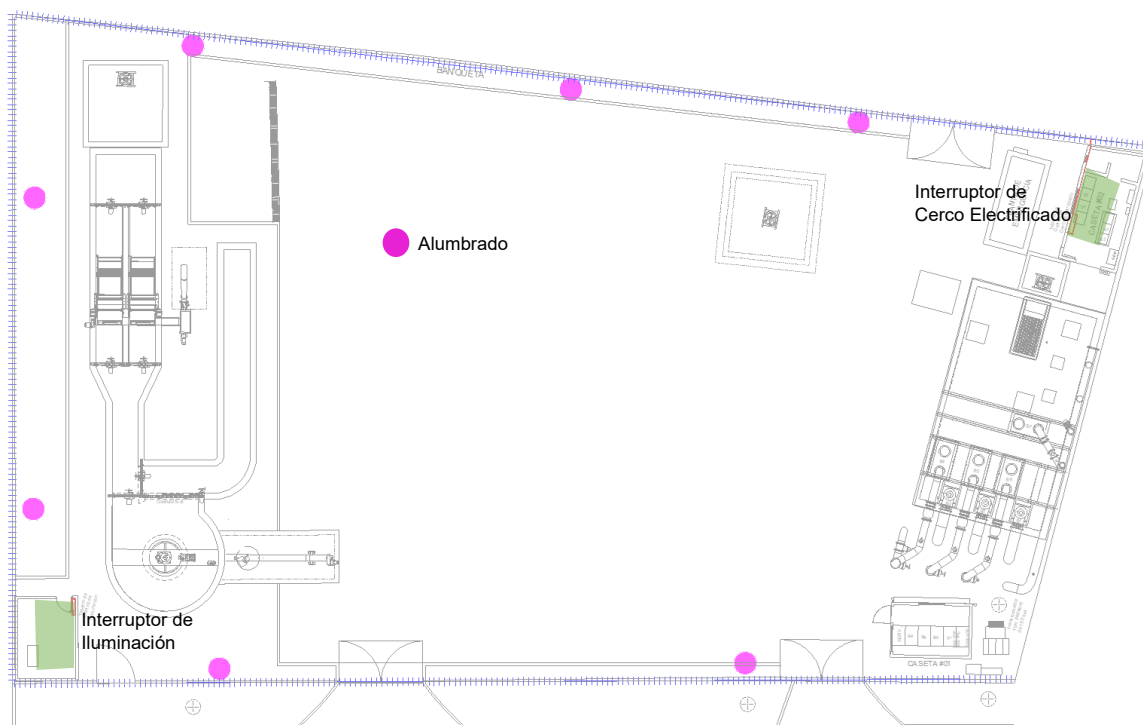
Ubicación en planta de Alumbrado, Cerco Electrificado y Serpentinatas
